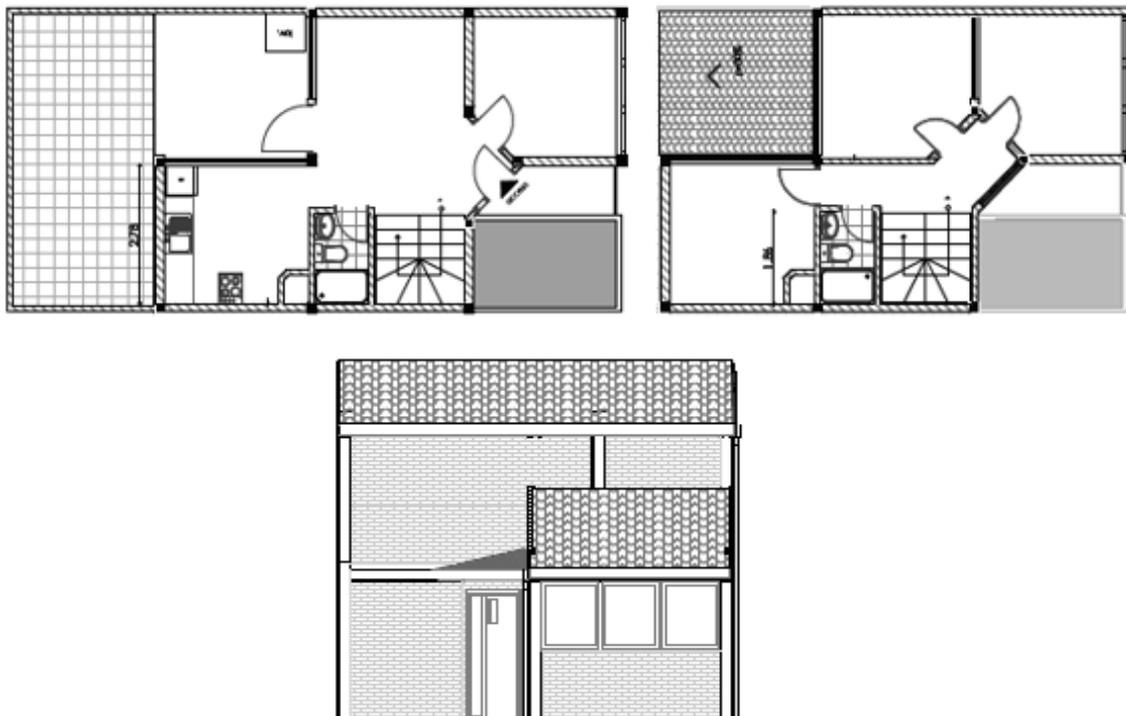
Planta Arquitectónica y fachada, vivienda 2 plantas tipo 2 urbanización “Los Nogales”.
